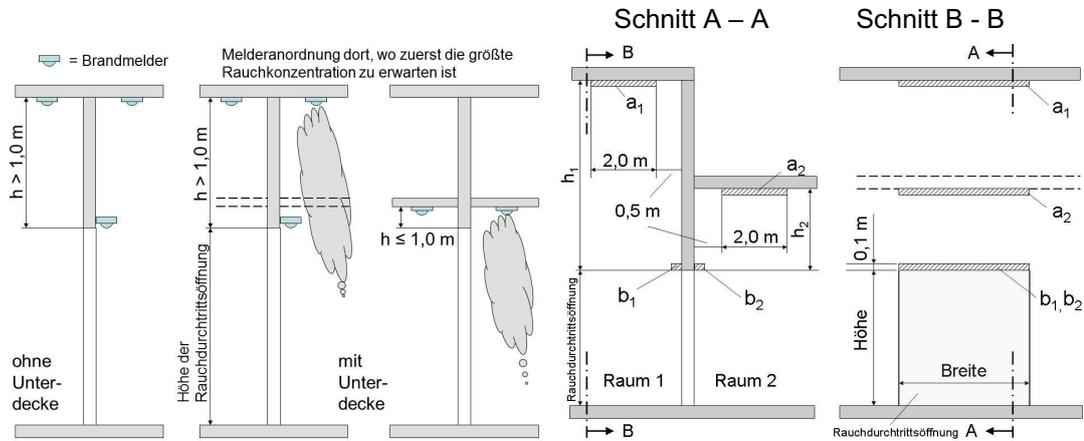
Maßgebende Höhe der Deckenunterfläche Bild 3: Installationsbereiche
